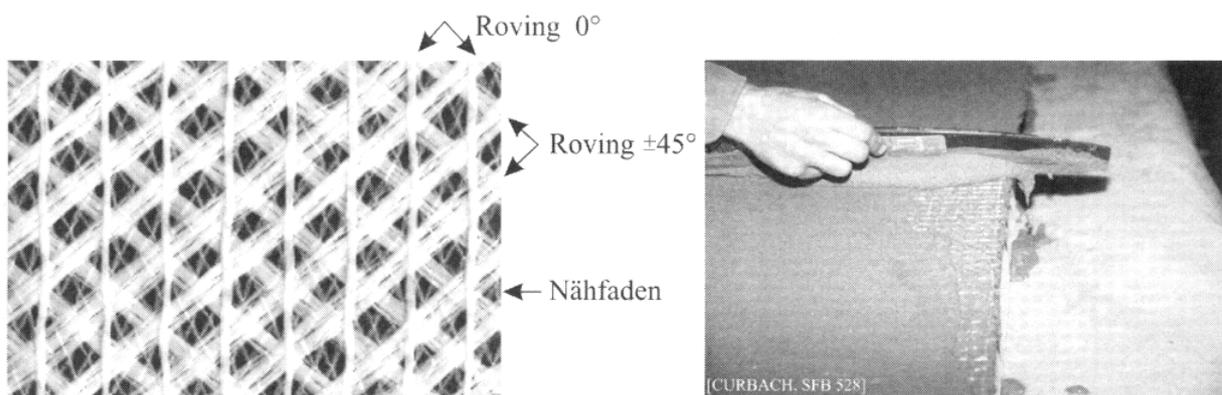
Glas-Gelege, textilbewehrter Stahlbeton
